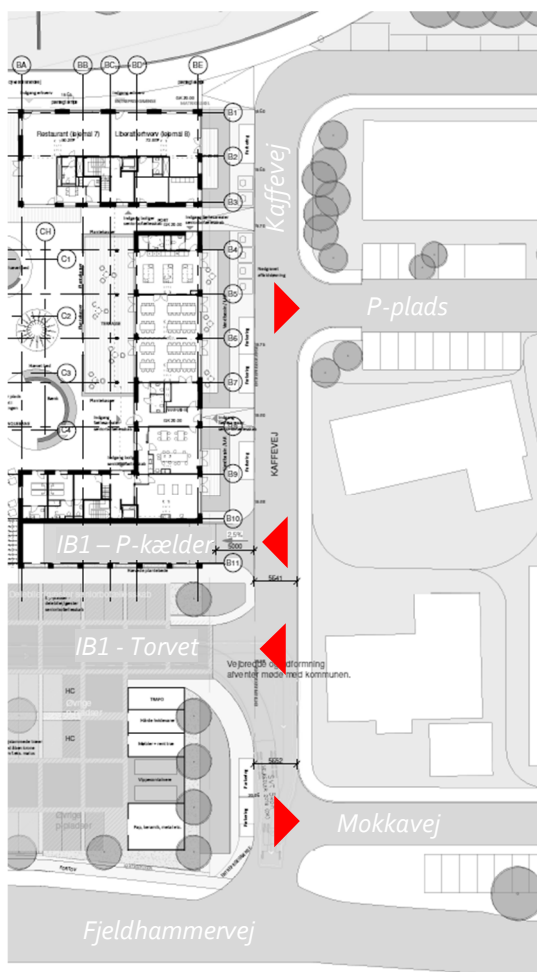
Placering af vejadgang til IB1 iht. lokalplan.
